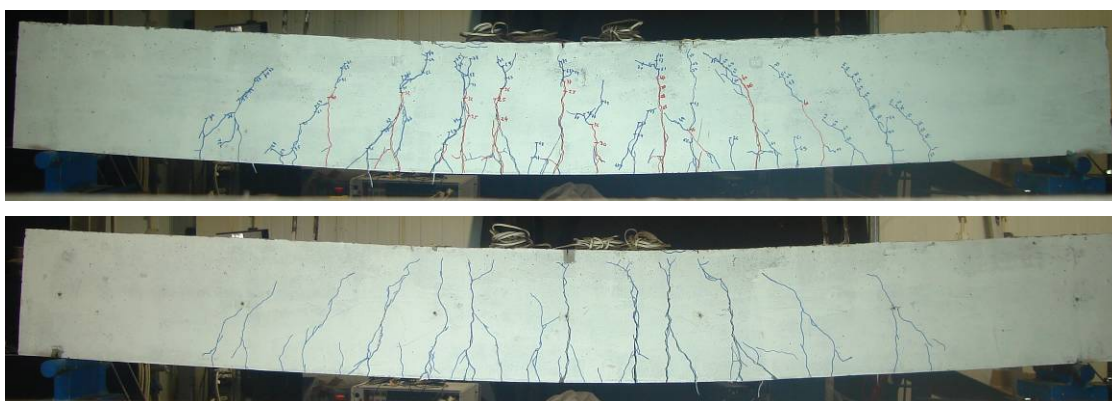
Padrão de fendilhação final instalado na viga S1-PC1.
